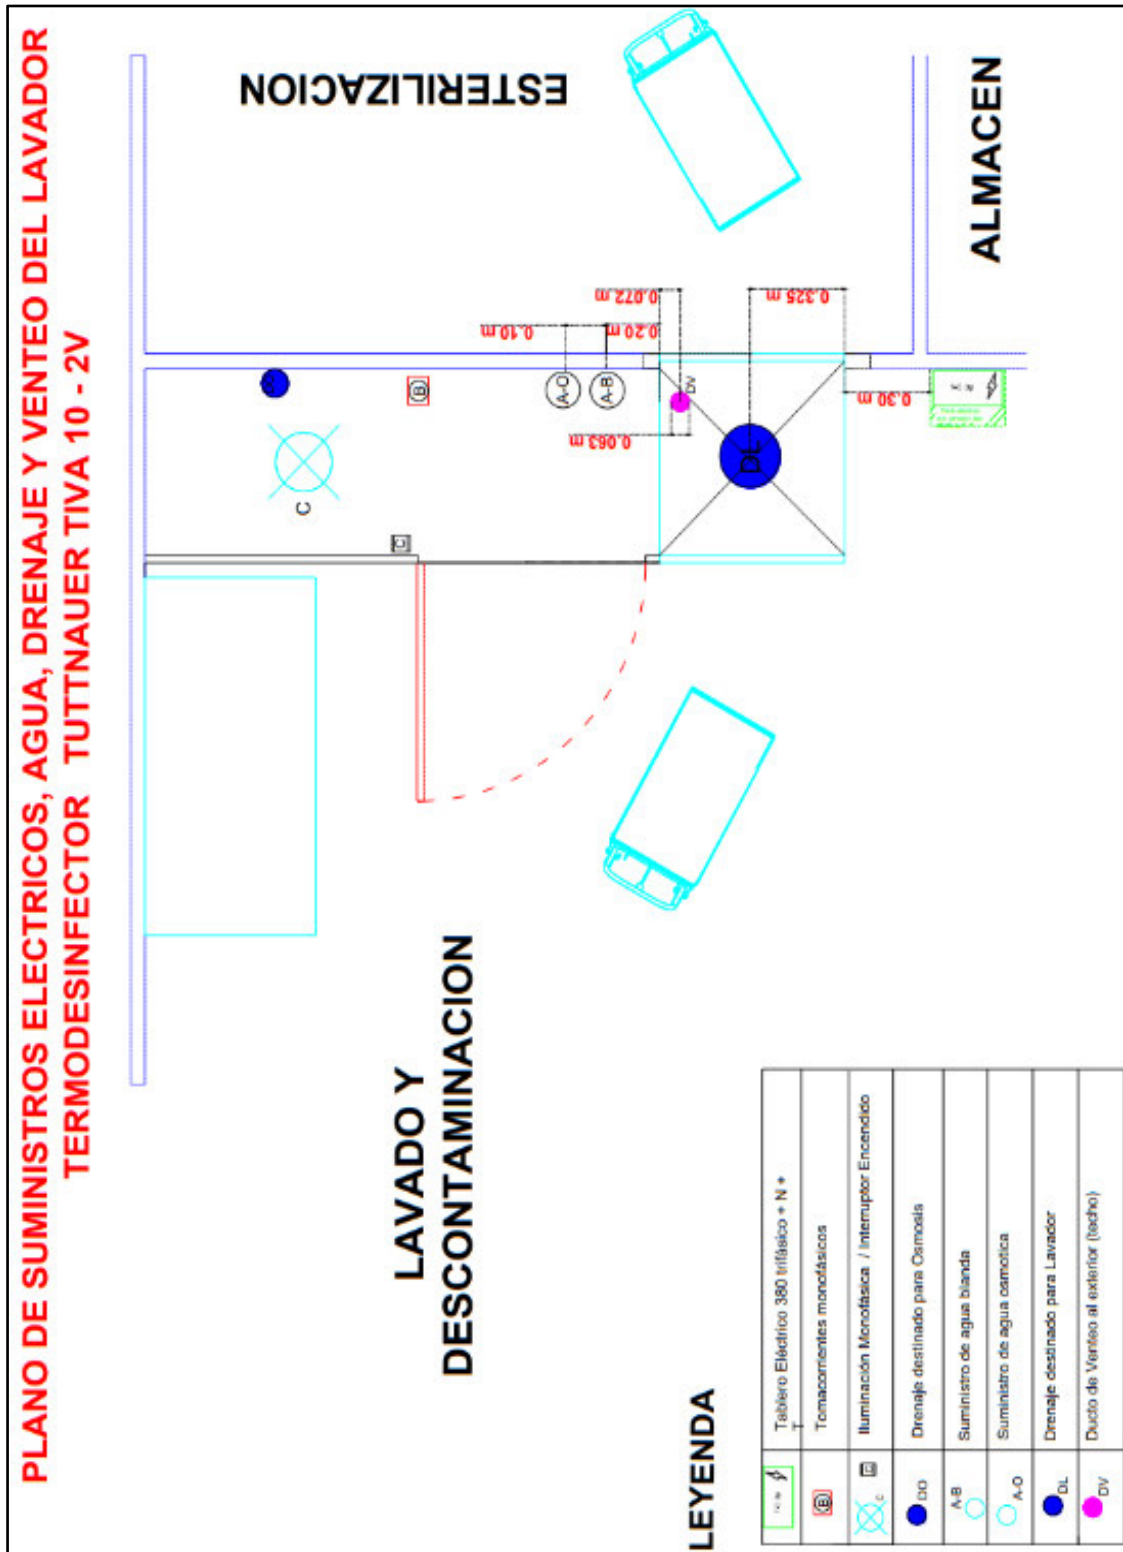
Plano 03 de Suministros – Área Roja. Fuente: propia
